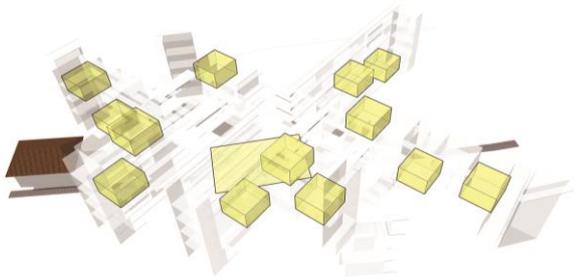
Denah Layoutplan. Sumber: penulis
